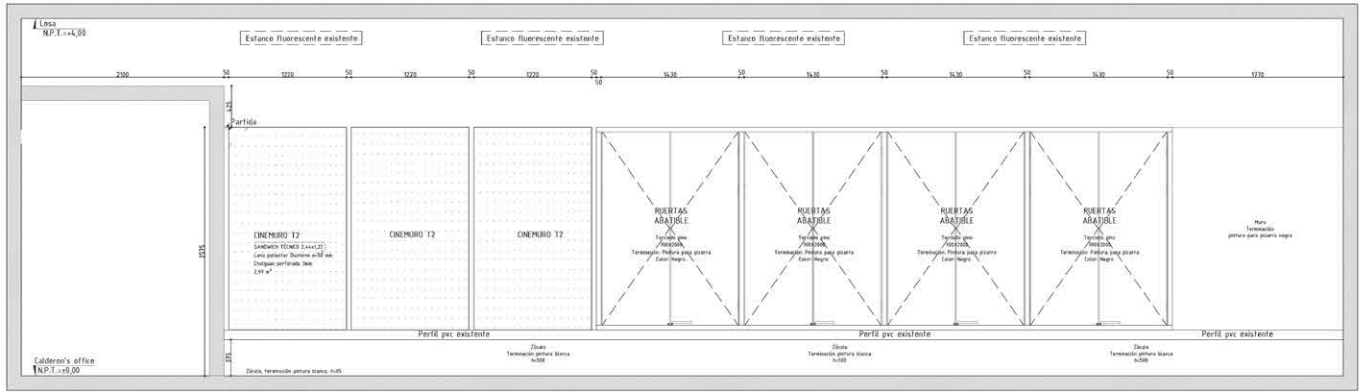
Alzado poniente. Fuente: Elaboración propia.
